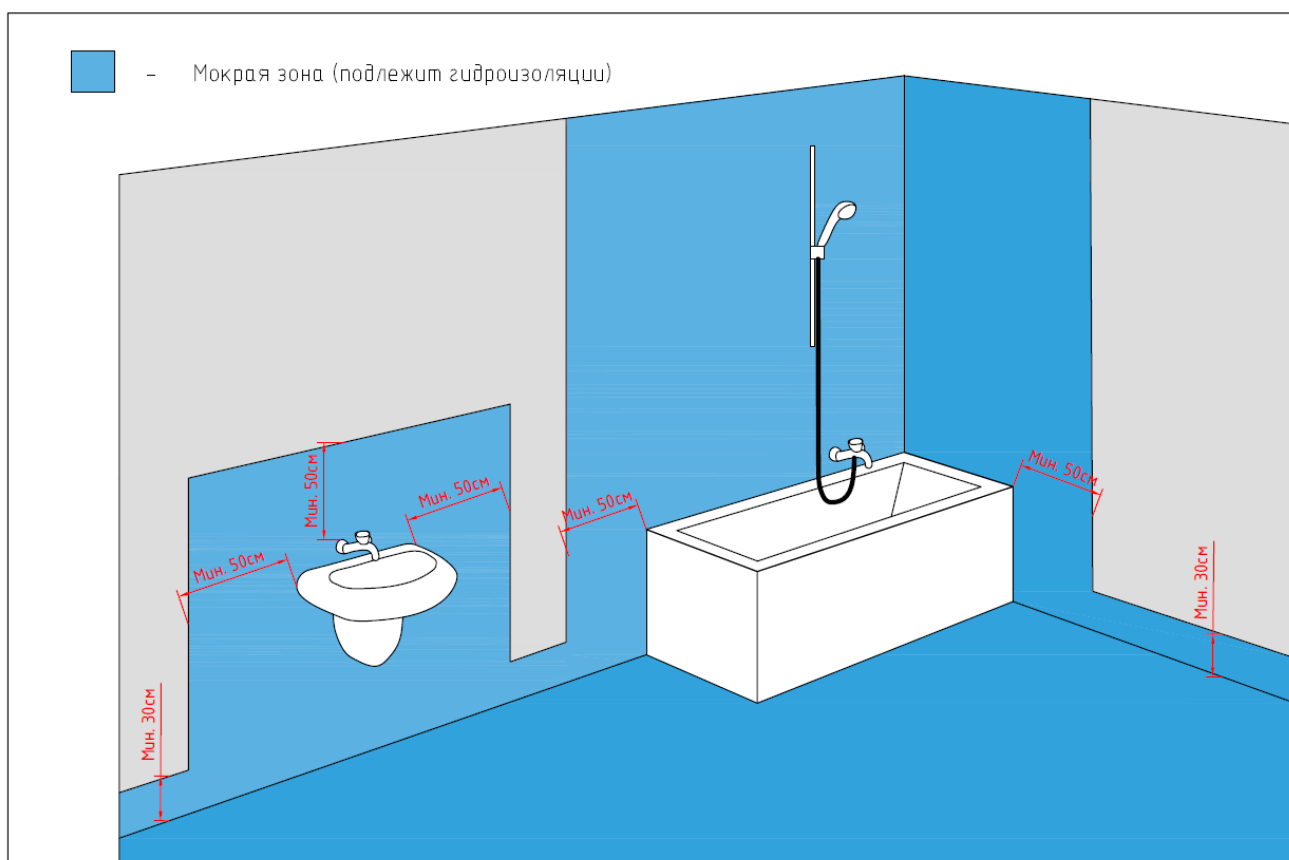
Мокрые зоны внутри влажных помещений, подлежащие гидроизоляции.
